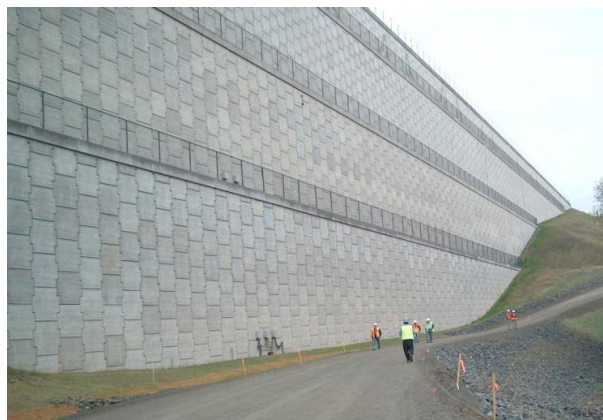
Fotografía del muro mecánicamente estabilizados ubicado en el aeropuerto SeaTac (FHWA,2009)
